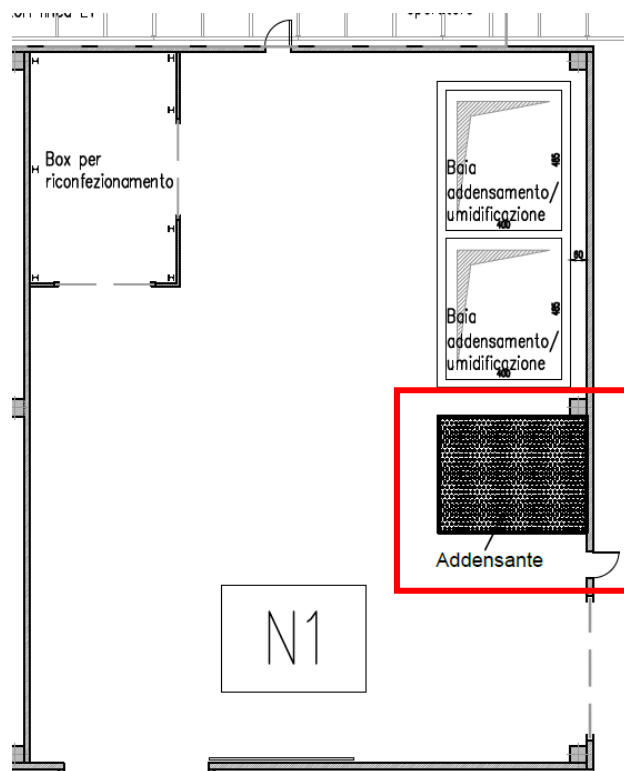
Area dedicata alla collocazione degli addensanti prima dell'utilizzo nella lavorazione (stralcio elaborato CO 05 RA AA 01 DT PL 03.04 - Allegato 3D AIA - PLANIMETRIA DELL'IMPIANTO (AREE DEPOSITO MATERIE – SOSTANZE E RIFIUTI))
